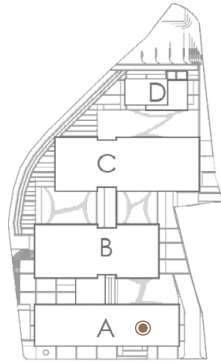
Detalle Planta Baja. Fuente: Autoría propia.
